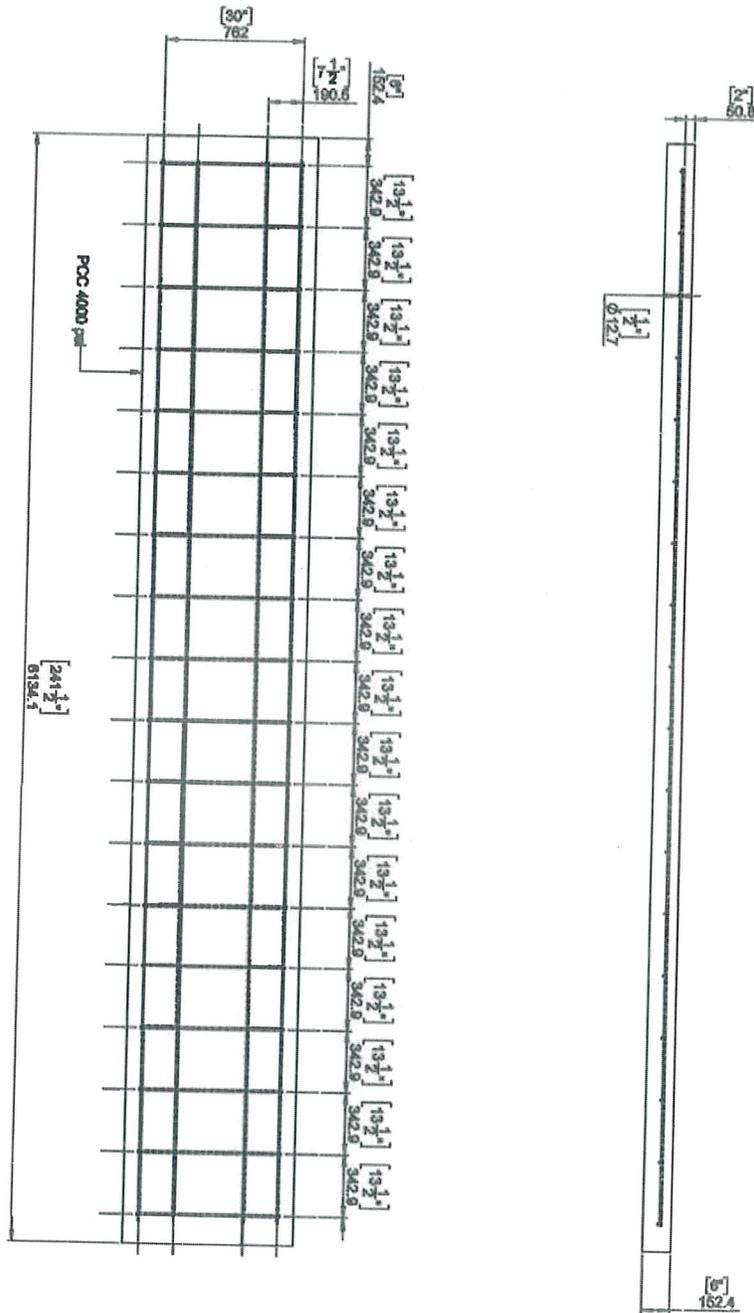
Base de concreto con malla metálica soldada (estándar de EE. UU.).
